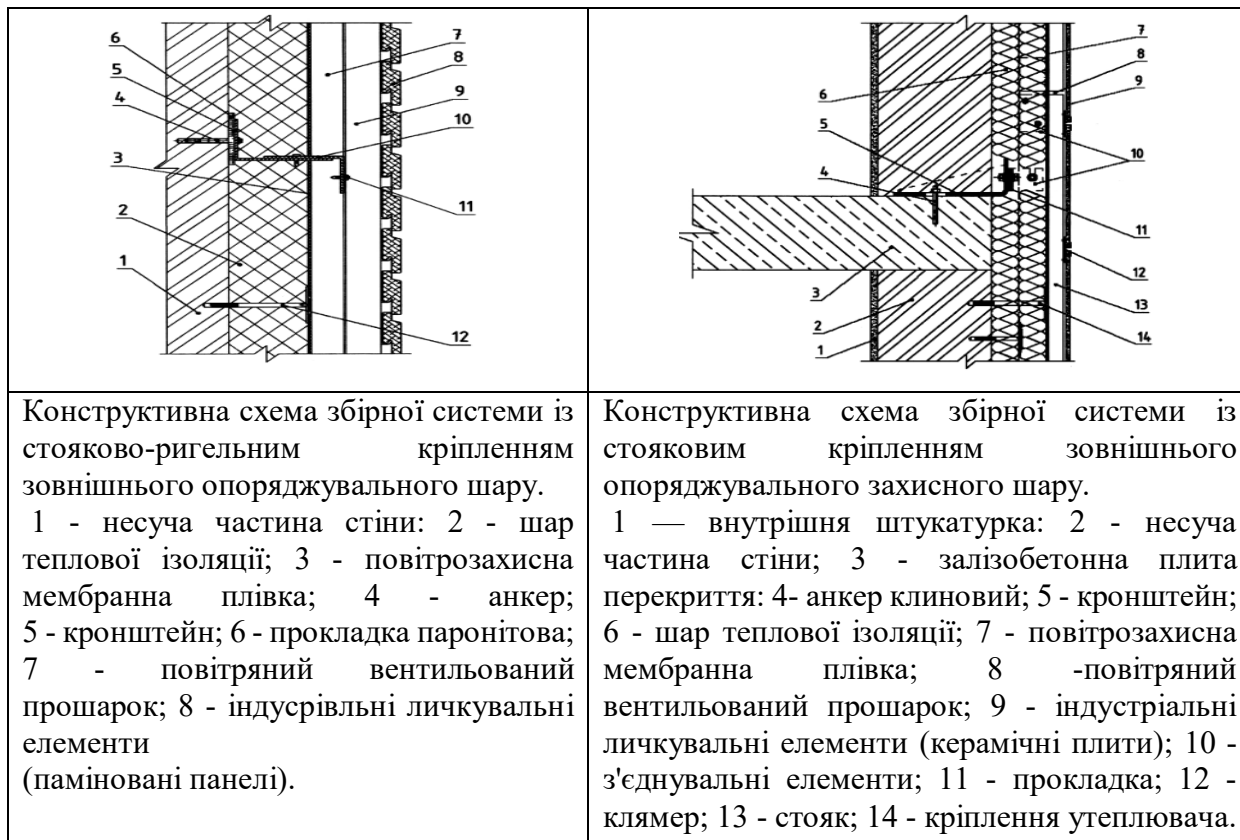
Конструктивна схема збірної системи із стояковим та стояково-ригельним кріпленням зовнішнього опоряджувального шару.
